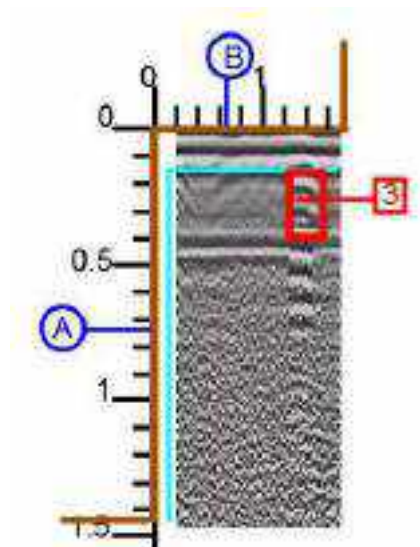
Sezione GPR orizzontale acquisita in faccia B ad altezza 1.5m da terra
